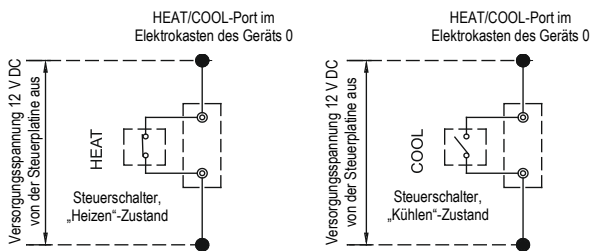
Anschluss des HEAT/COOL-Ports
